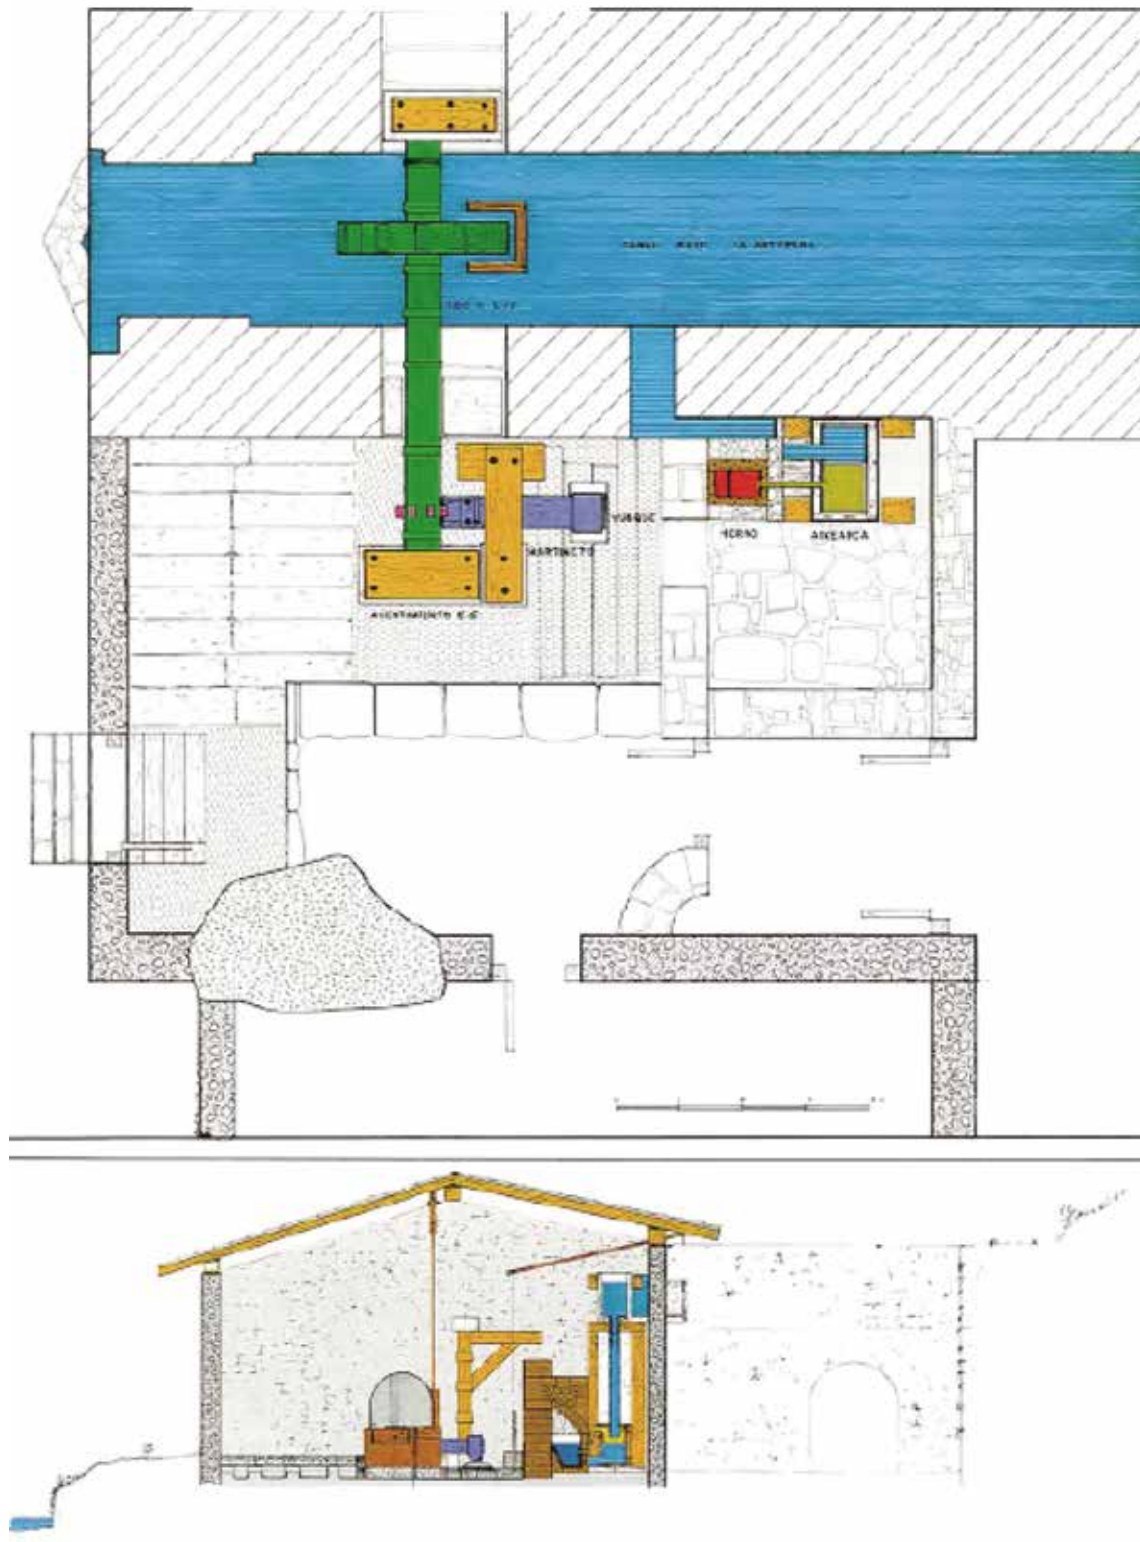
Planta y alzado del martinete con trompa hidráulica de la ferrería de Olaberria (Oiartzun, Gipuzkoa). Fase III.
